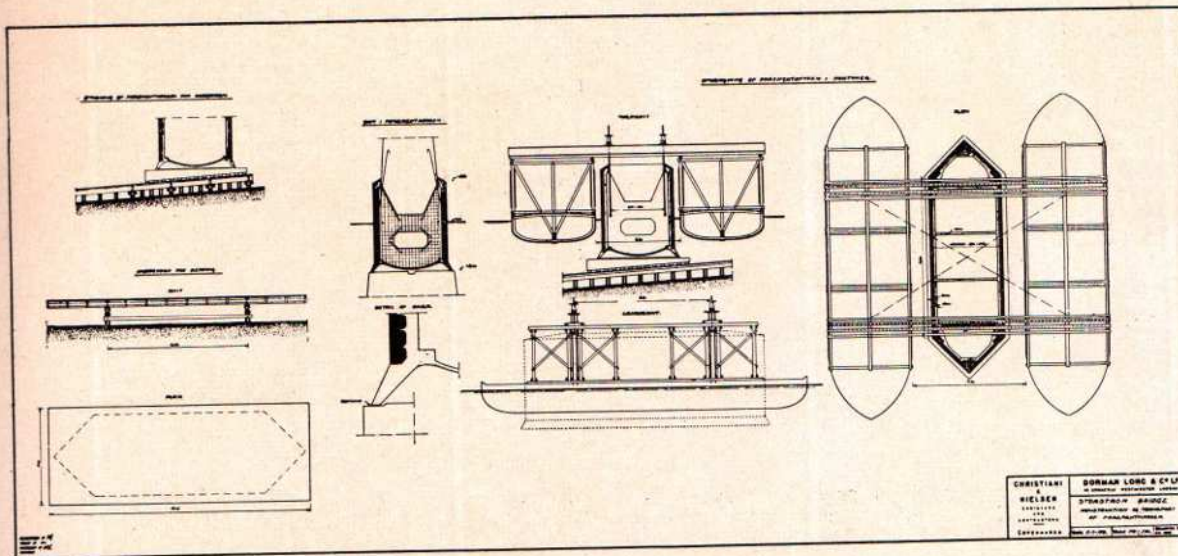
Planta mostrando como a parte central do pilar revestida de granito é construída á secco em uma carreira, em seguida lançada e rebocada entre dois pontões e finalmente collocada em posição sobre a fundação em baixo d'agua
